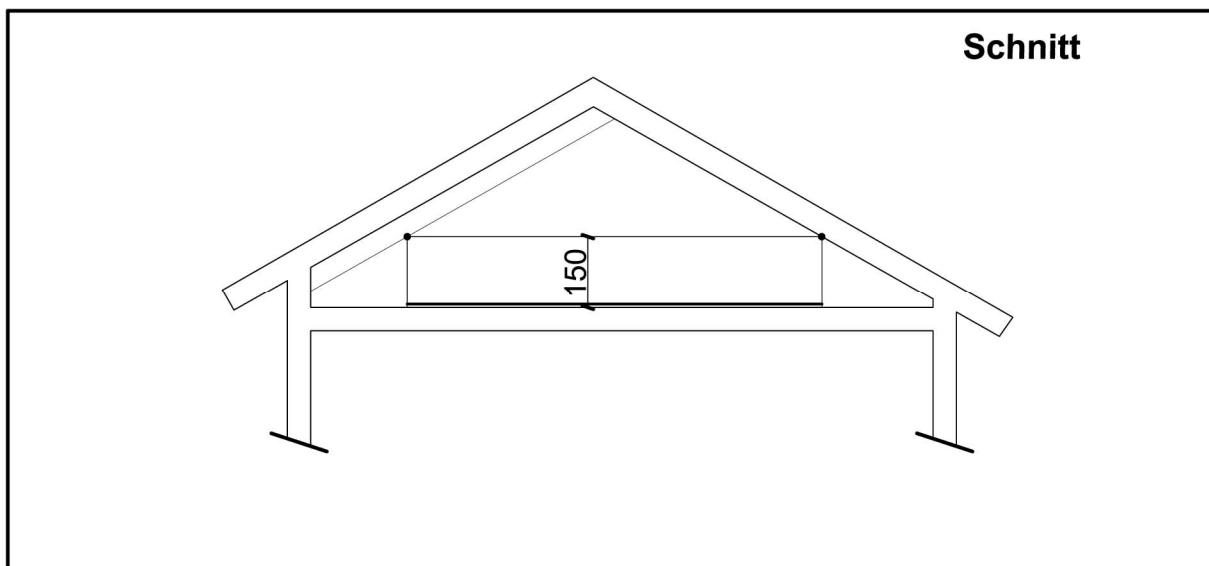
Bruttogeschoßfläche im Dachgeschoss (dicke Linie)
